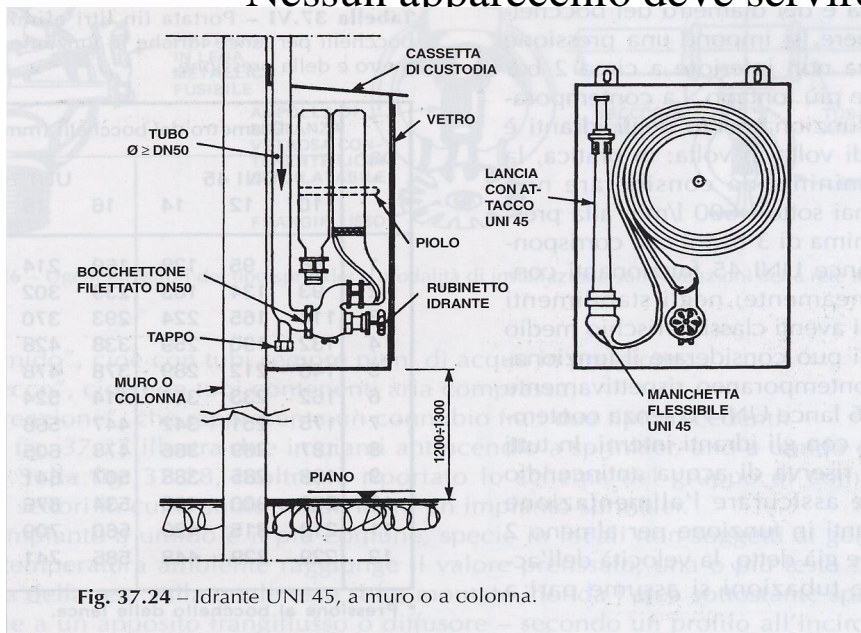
Idrante UNI 45, a muro o a colonna.
